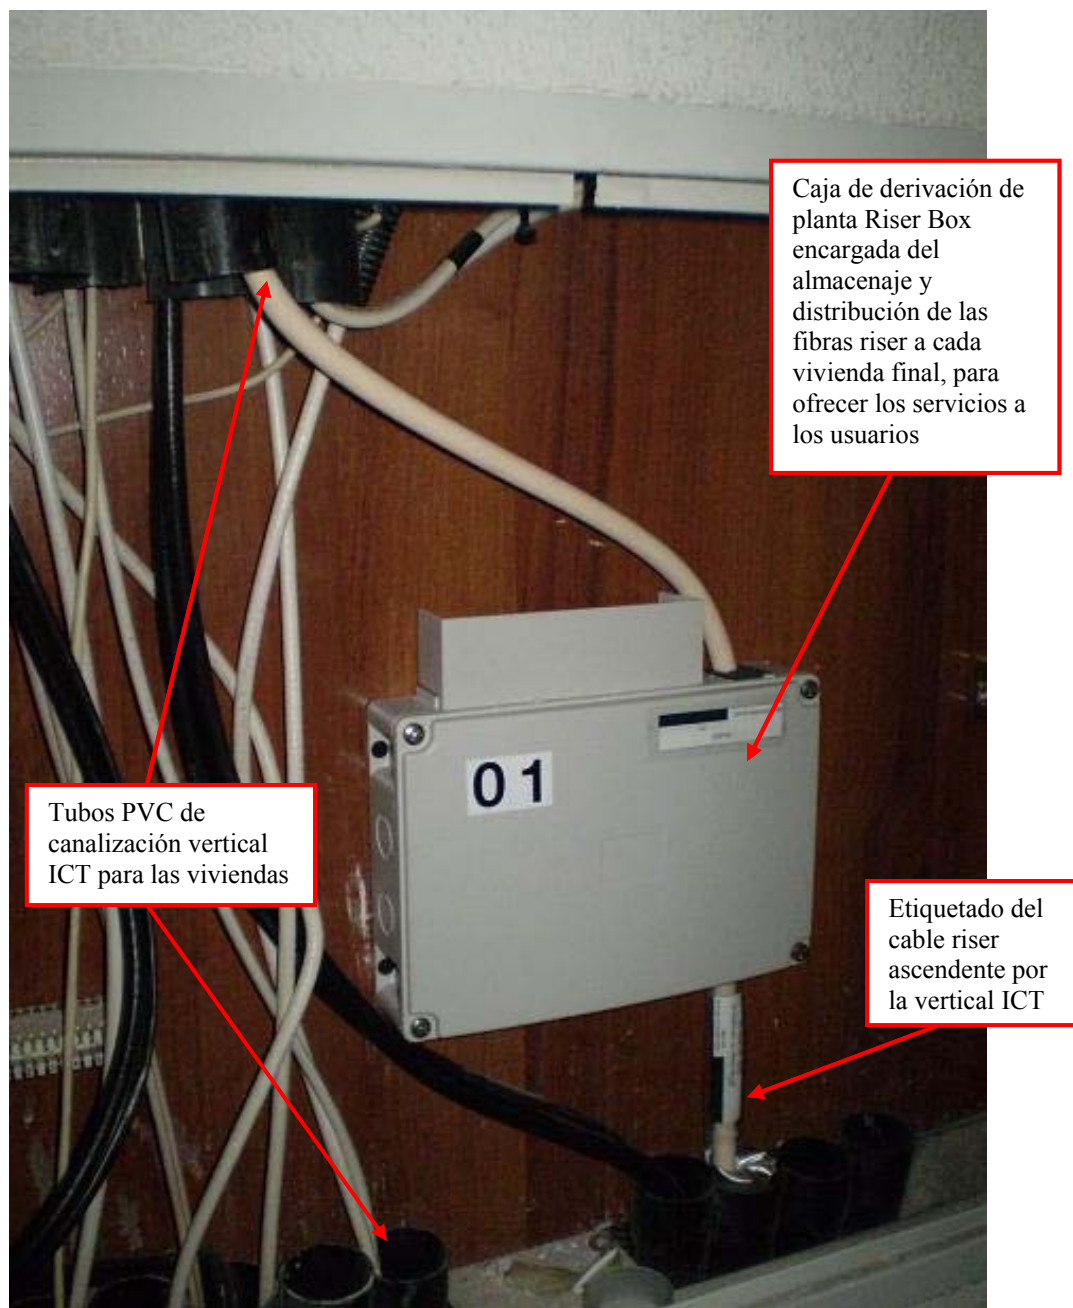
Vista de puerta de acceso al patinillo de canalización ICT vertical de las viviendas (planta 1ª)
